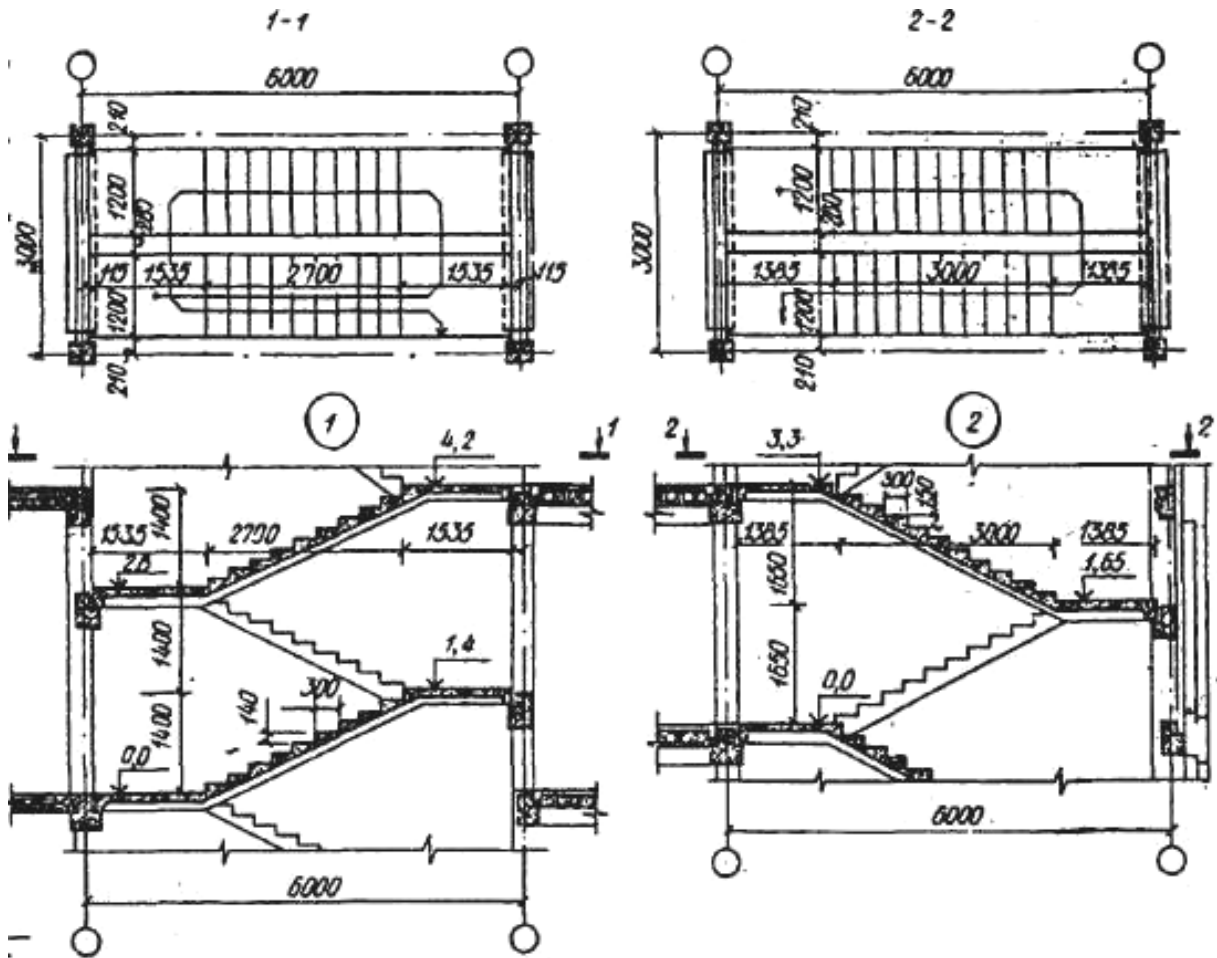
Варианты конструктивных решений лестничных клеток в каркасно-панельных зданиях (узел 1 – лестничная клетка в среднем пролёте при высоте этажа 4,2 м; узел 2 – лестничная клетка в крайнем пролёте при высоте этажа 3,3 м)
